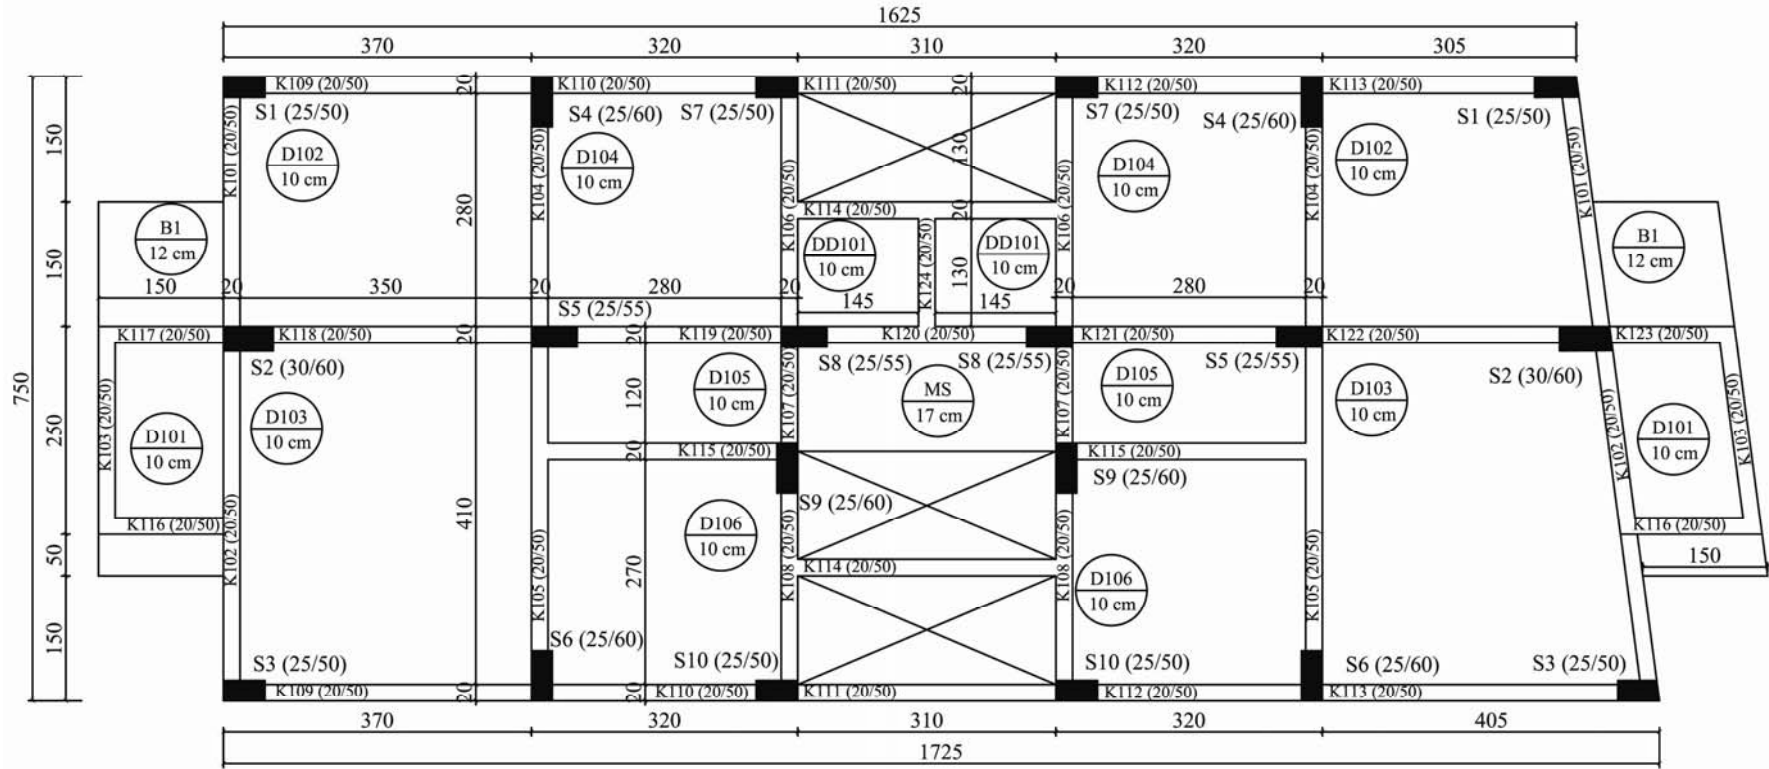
B5\_4'ün kat kalıp planı
